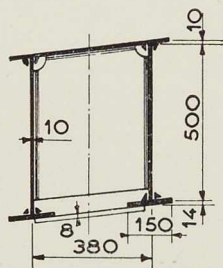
Coupe dans les traverses en caisson du contreventement supérieur.
